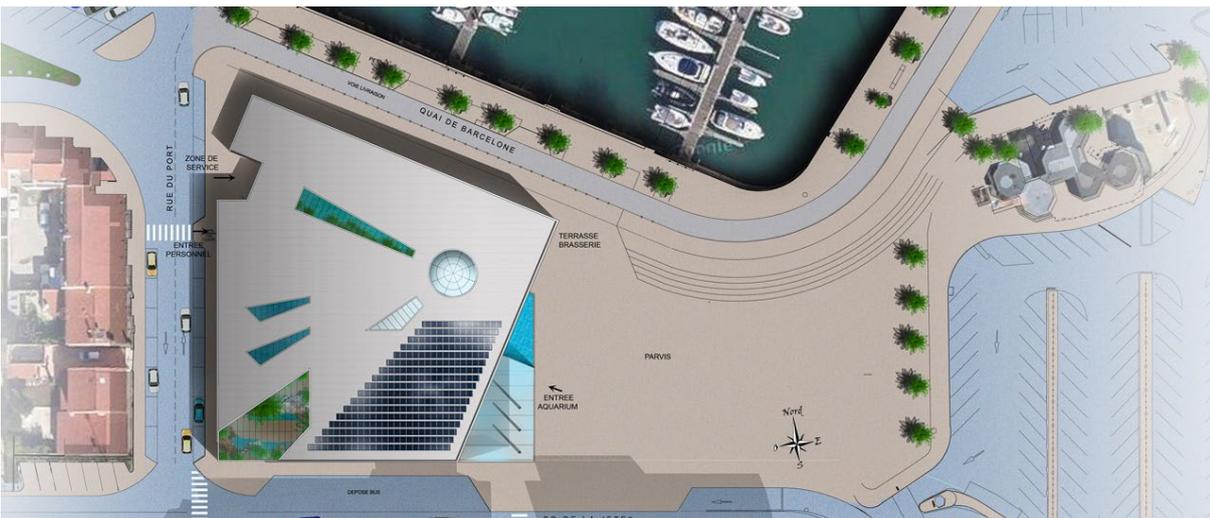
Plan de masse du projet d’Aquarium de Canet-en-Roussillon (Ville de Canet-en-Roussillon)
